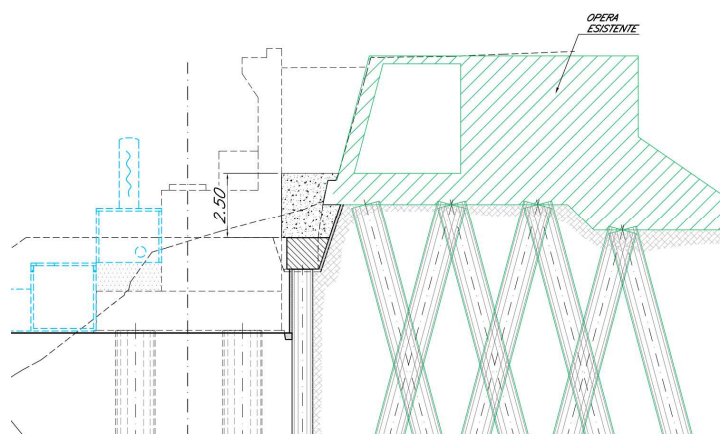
Spalla B, Incremento di spinta sul paramento della spalla. Caso statico
